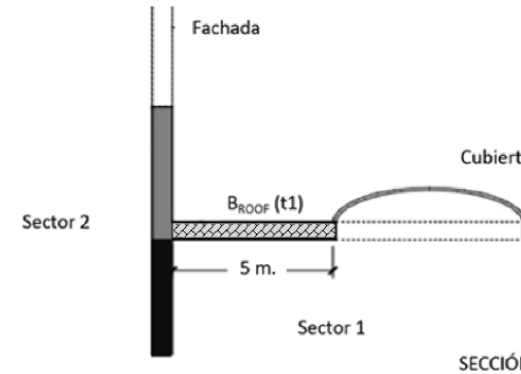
Reacción al fuego de la cubierta, en el encuentro cubierta-fachada
